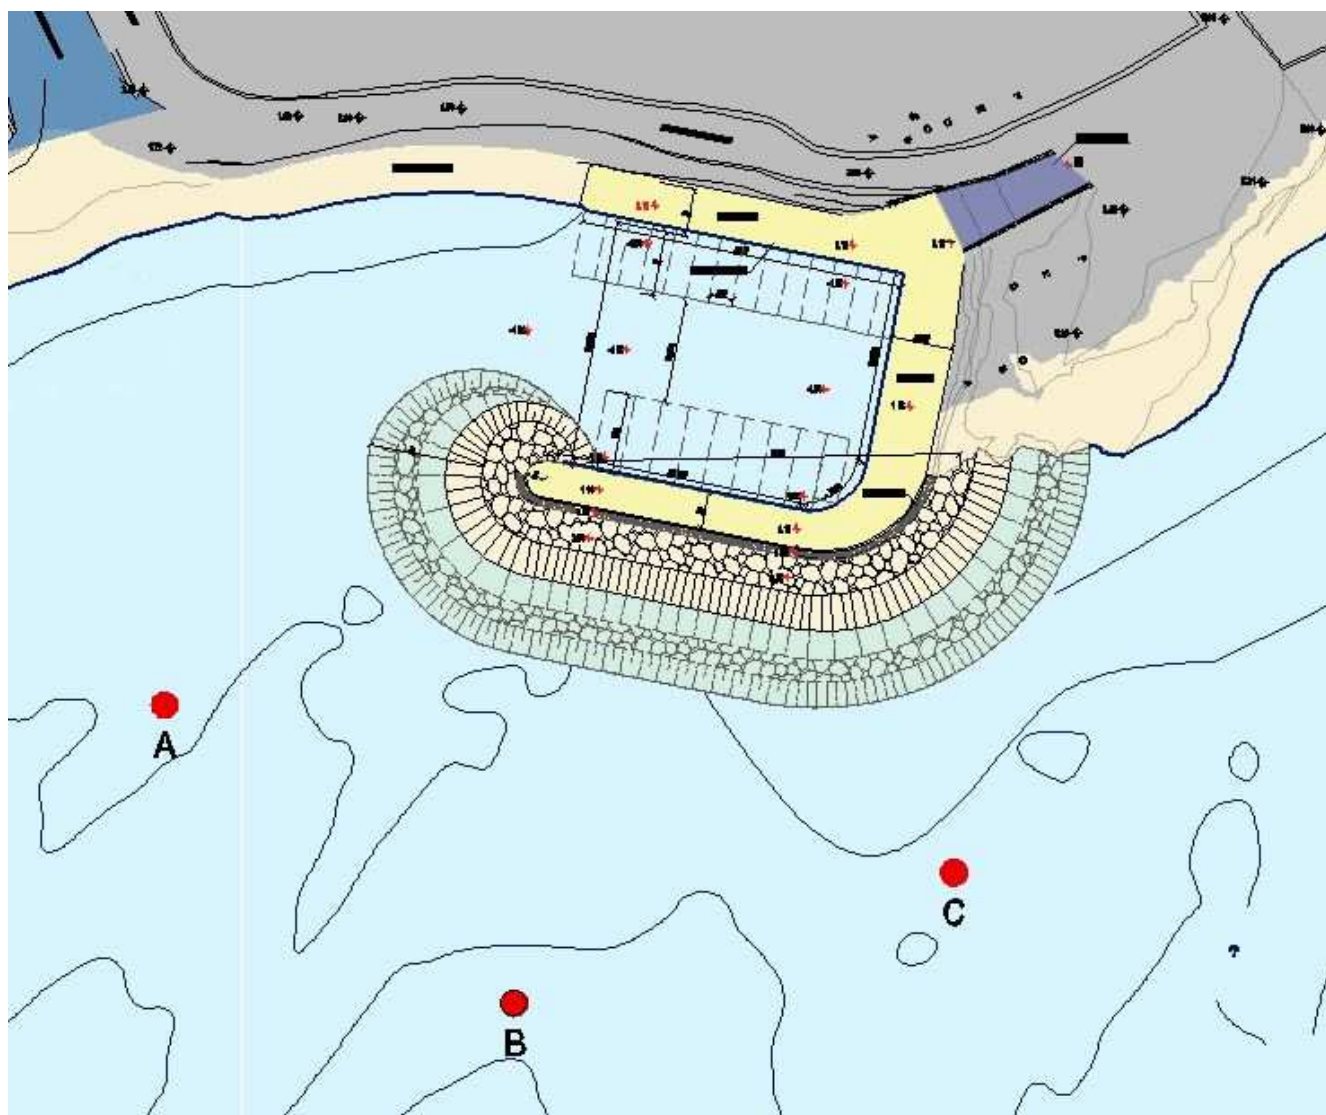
Planimetria di progetto con individuazione dei punti di rilevamento.
